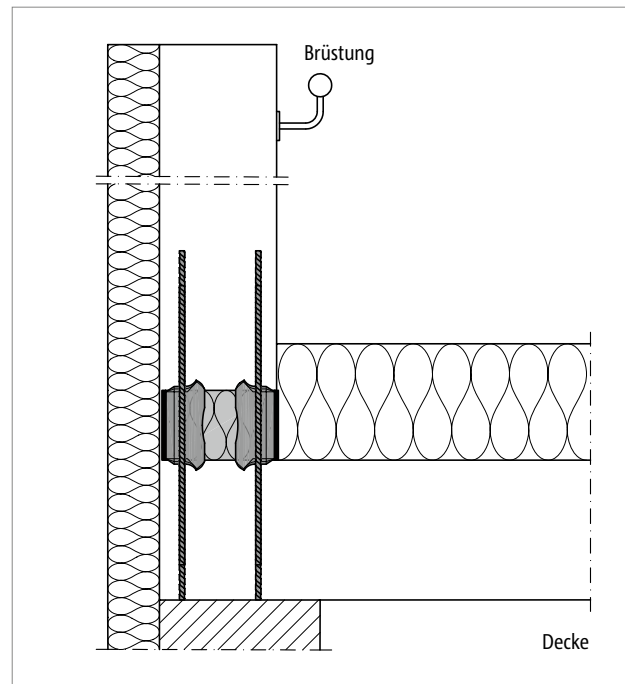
Schöck Isokorb® CXT Typ A: Anschluss einer Brüstung
